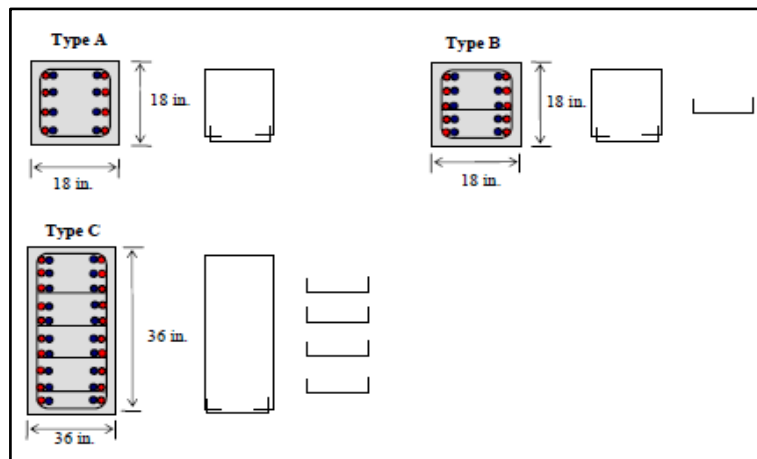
Detalles del Reforzamiento Transversal. Adaptado de " Use of CFRP to provide continuity in Existing Reinforced Concrete Members Subjected to Extreme Loads ", p.191, por Kim, 2008.
